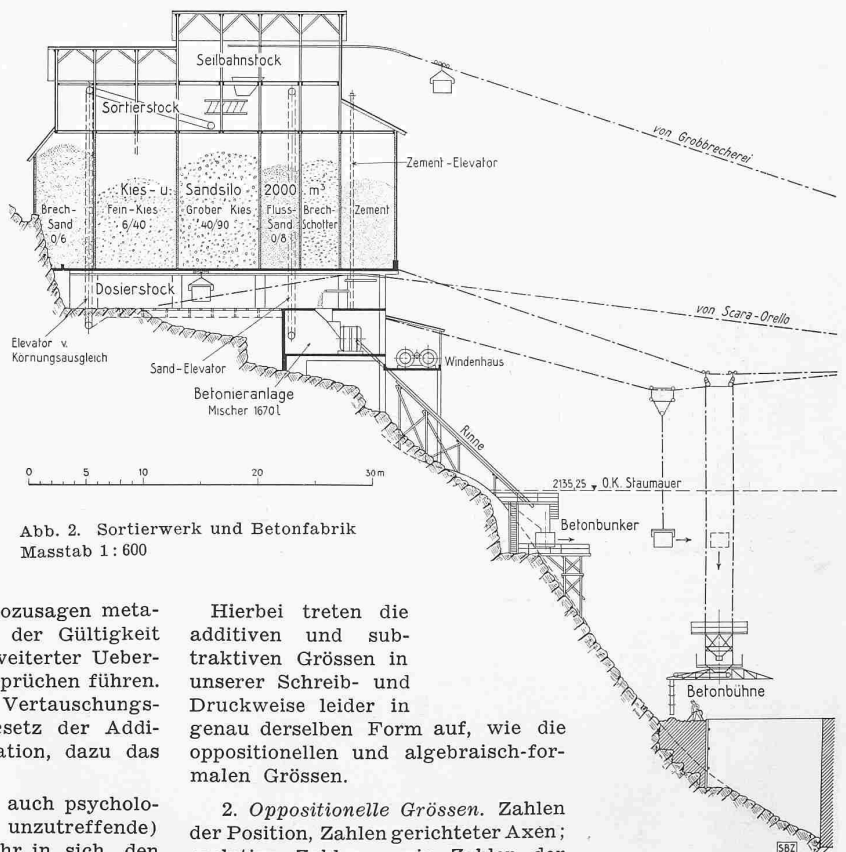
Sortierwerk und Betonfabrik Masstab 1:600
